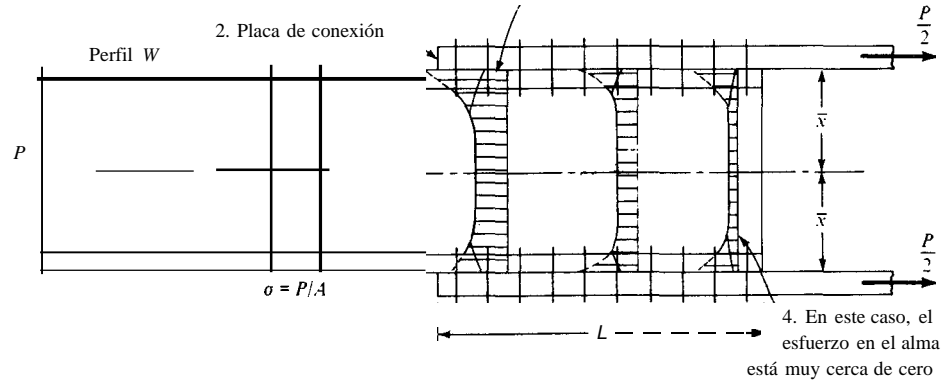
Rezago del cortante en un perfil W conectado a un par de placas de conexión.
